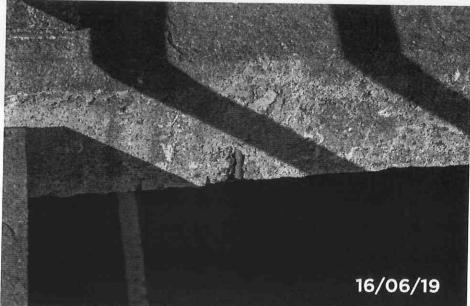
Detalhe armadura exposta laje do tabuleiro.
